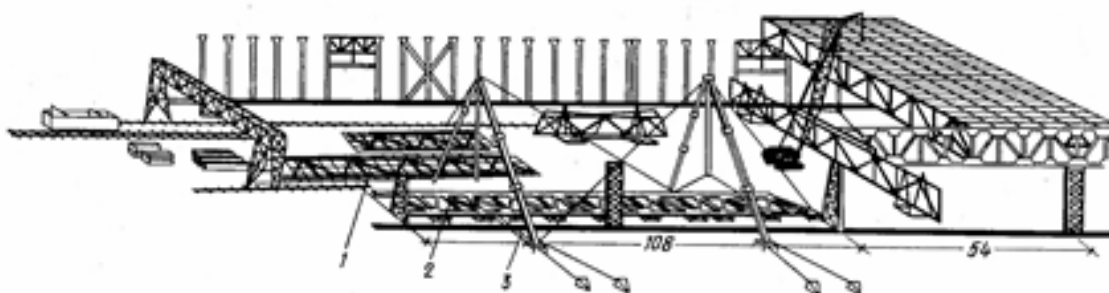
Схема монтажа покрытия самолеторемонтного цеха в Минеральных Водах:
